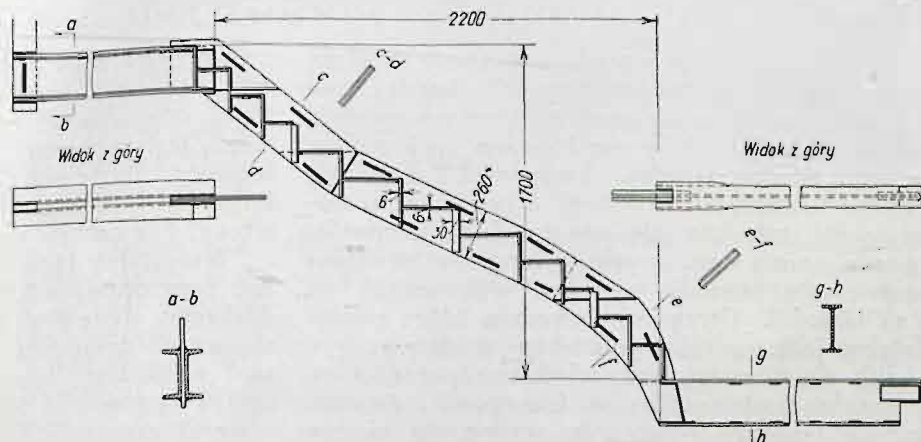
Konstrukcja schodów głównych i szczegół przegubu B.
